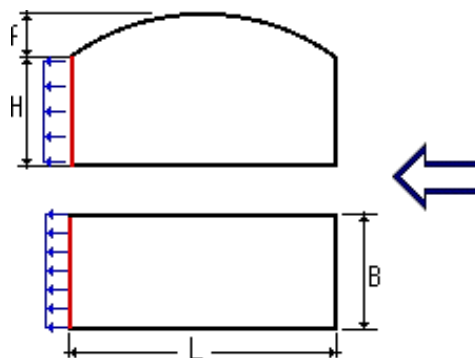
Схема будівлі з напрямком вітрового впливу
